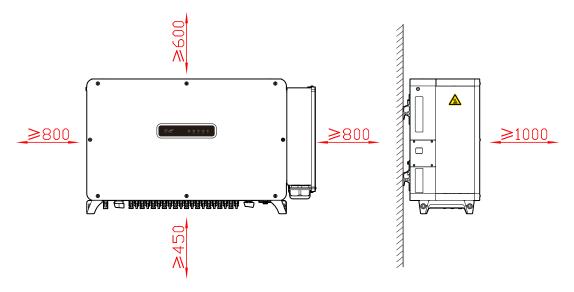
Spazio d'installazione (unità di misura: mm)
